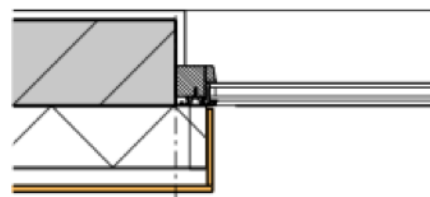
Détail en plan de la façade arrière (A2M, 2010)
